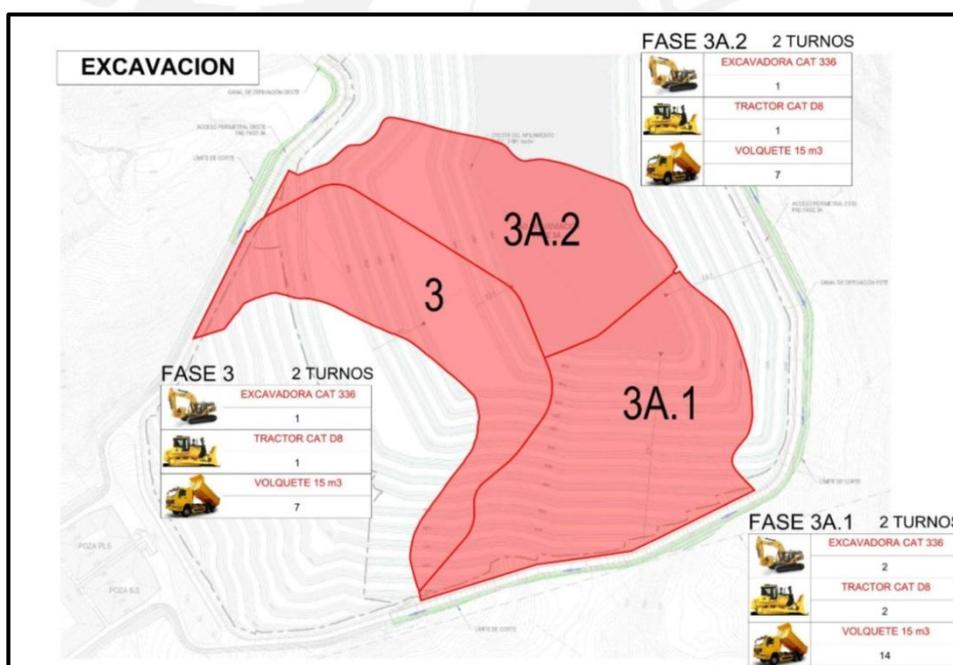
Distribución de equipos por sectores – Excavación (Elaboración propia)
